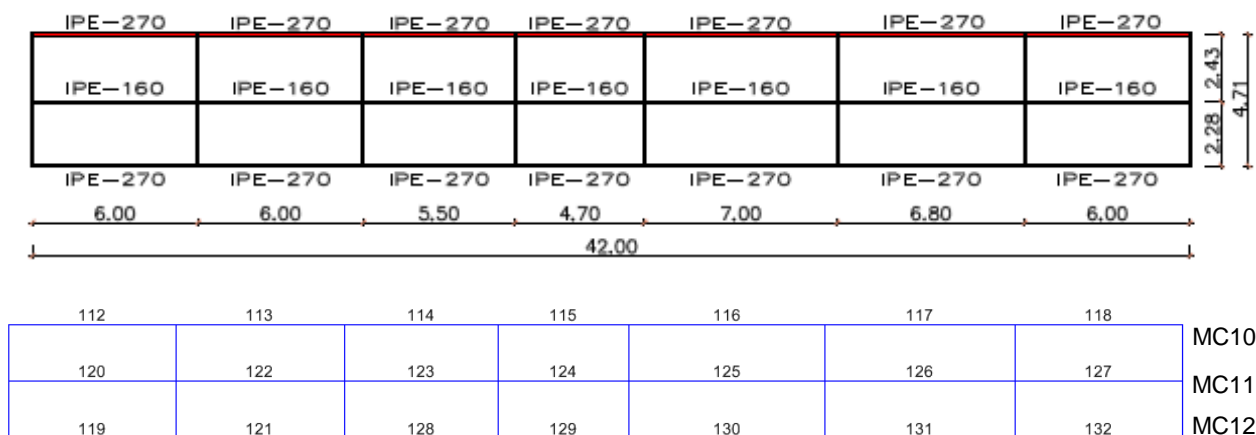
Planta com a Geometria e Identificação das Vigas da Cobertura 3.
